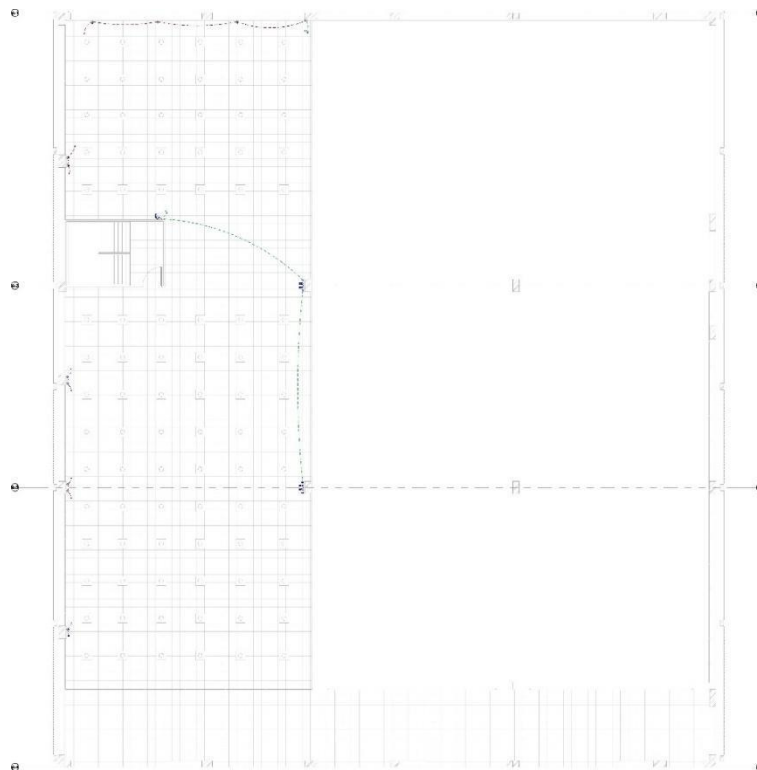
Planta Producción Nivel 2 – Tomacorrientes
